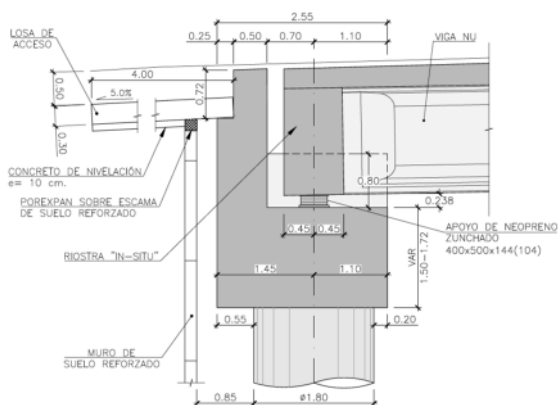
Detalle apoyo estribo E-11 para solución con tablero continuo.
